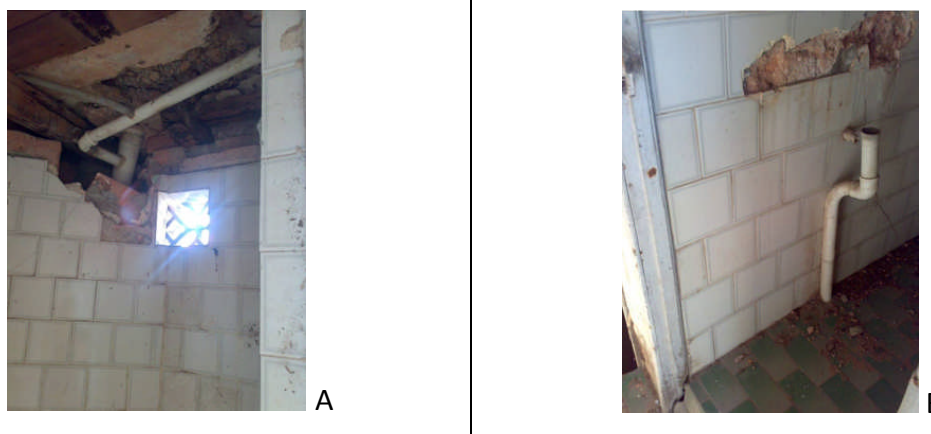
Alteração Estrutural. (A) e (B) Passagem de tubulações hidrossanitárias na estrutura. Solar nº 46 Rua Afonso Pena. (3ª SR/IPHAN-2010).
